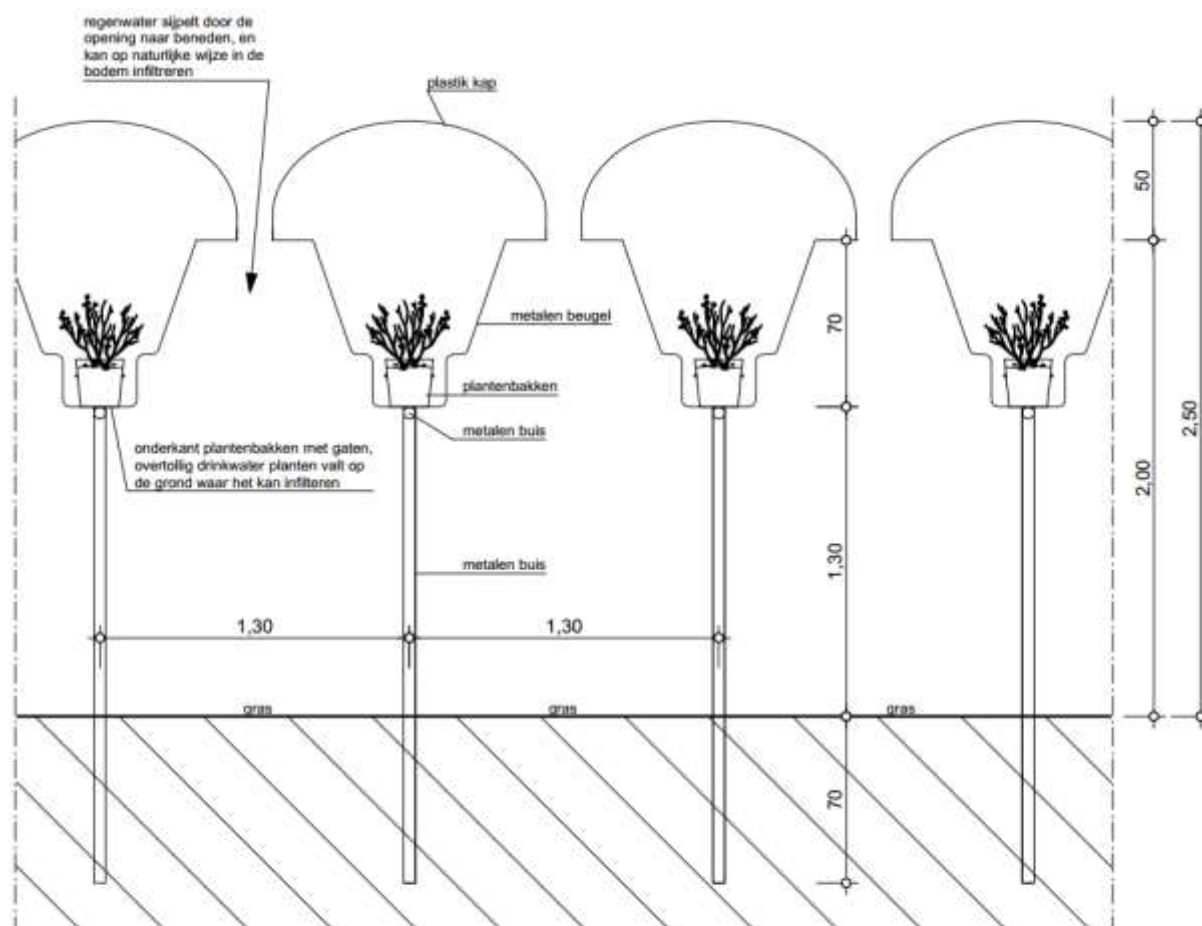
Funderings- en grondplan van de af te breken stellingteelt¹⁰
